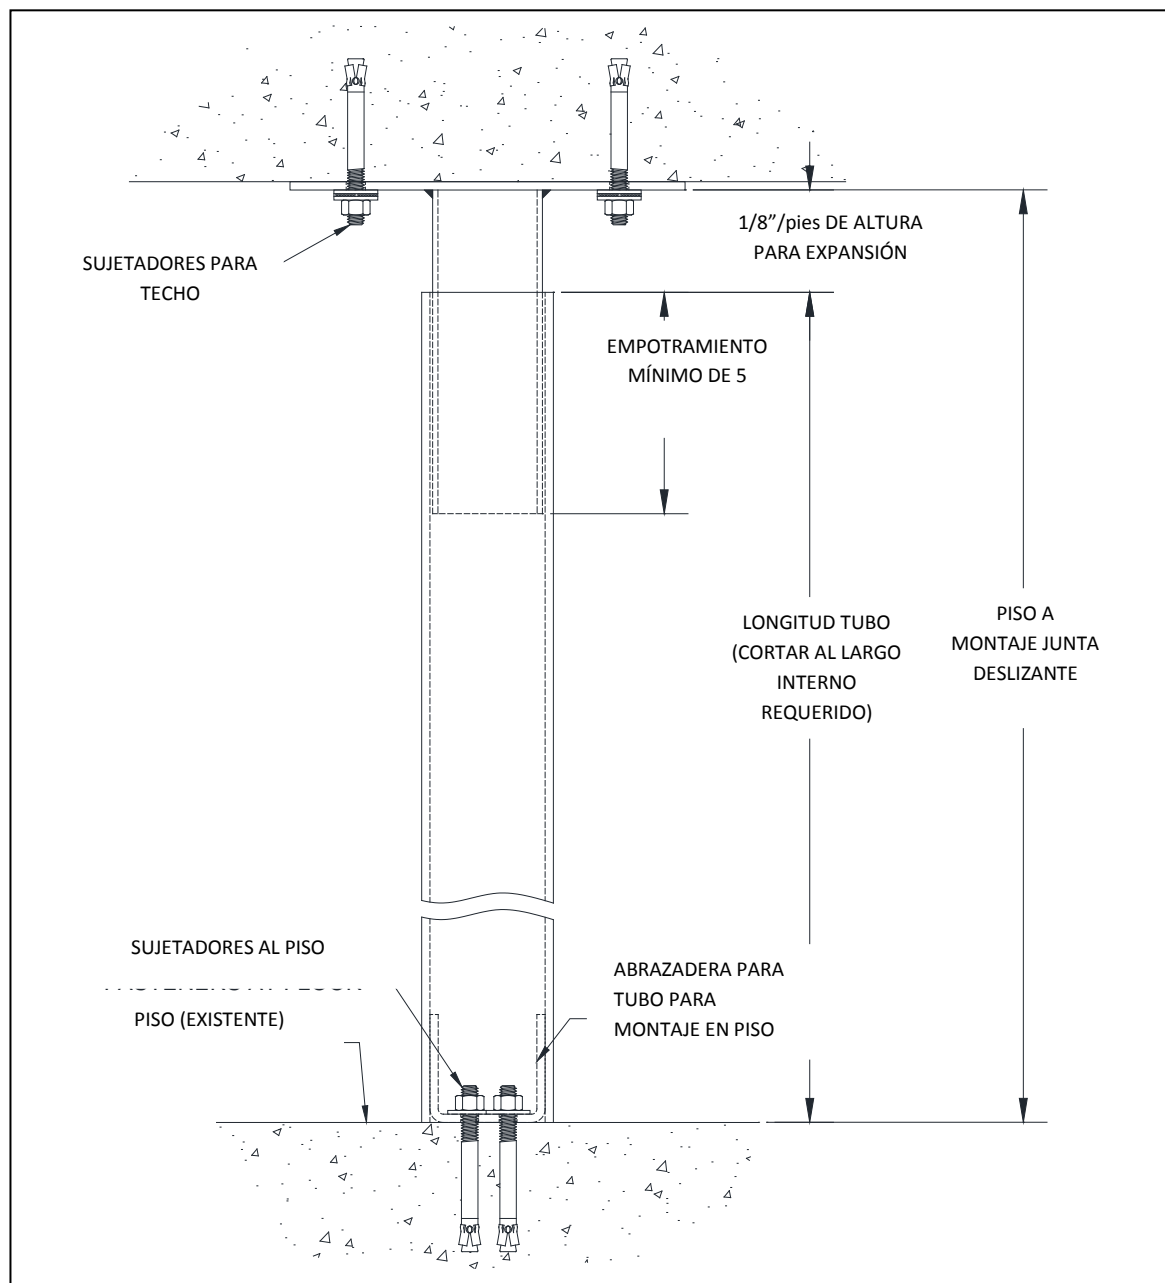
Junta Deslizante entre piso y ensamblaje de montaje de techo.
